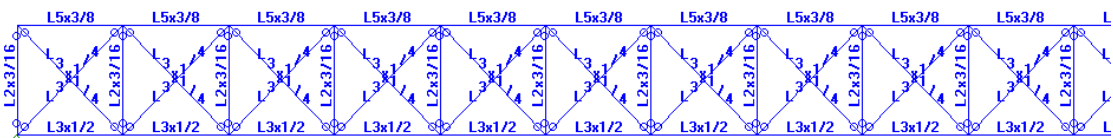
Perfis viga treliçada TIPO B – Treliça Contraventada
